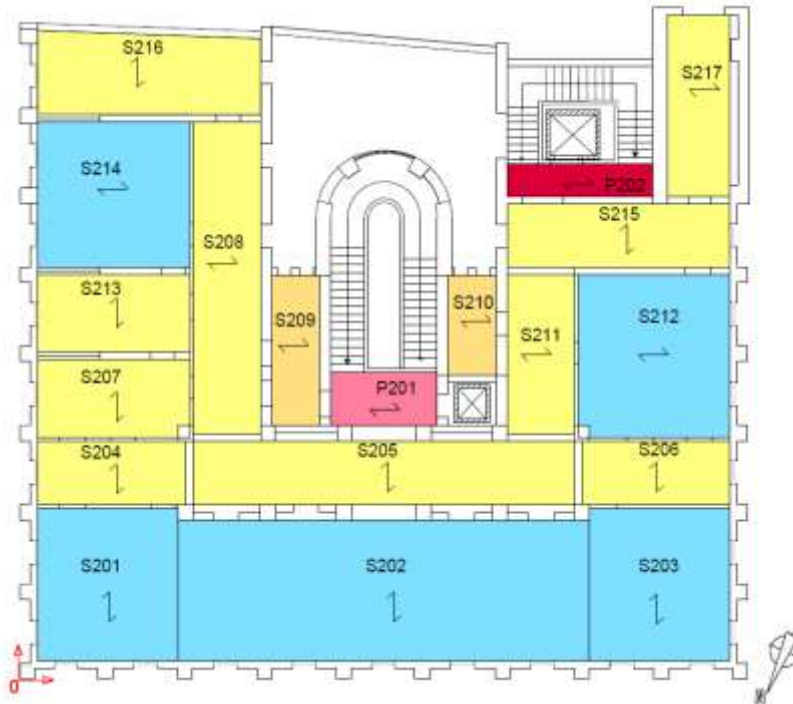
Pianta chiave dei solai; terzo orizzontamento.
